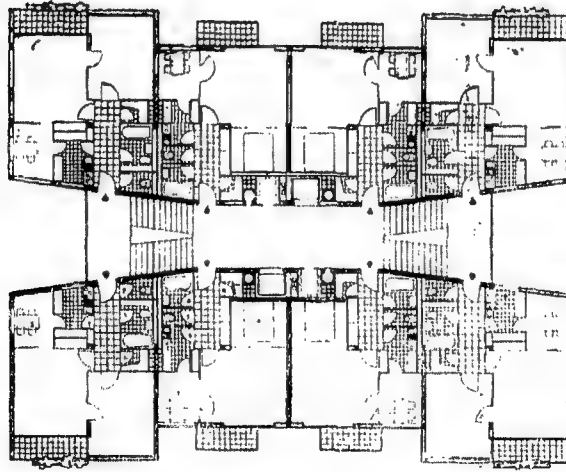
١٠ - ٢ : مسقط الدور المتكرر .
